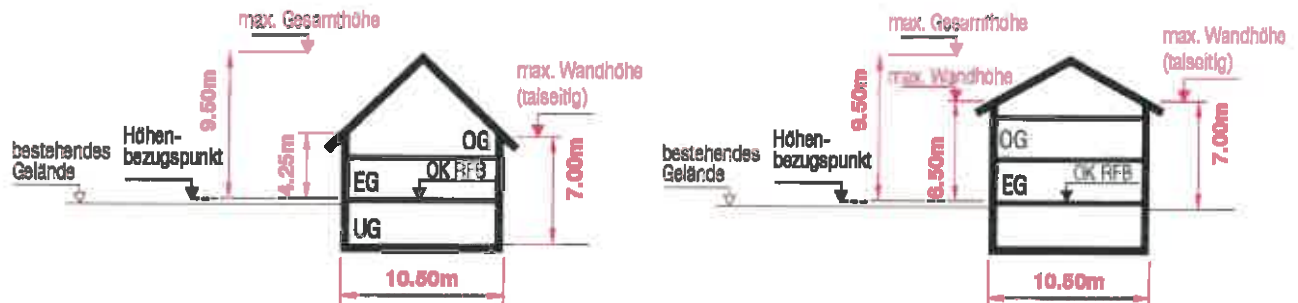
Beispielhafte Gebäudetypen mit Satteldach im WA 1 und WA 2
